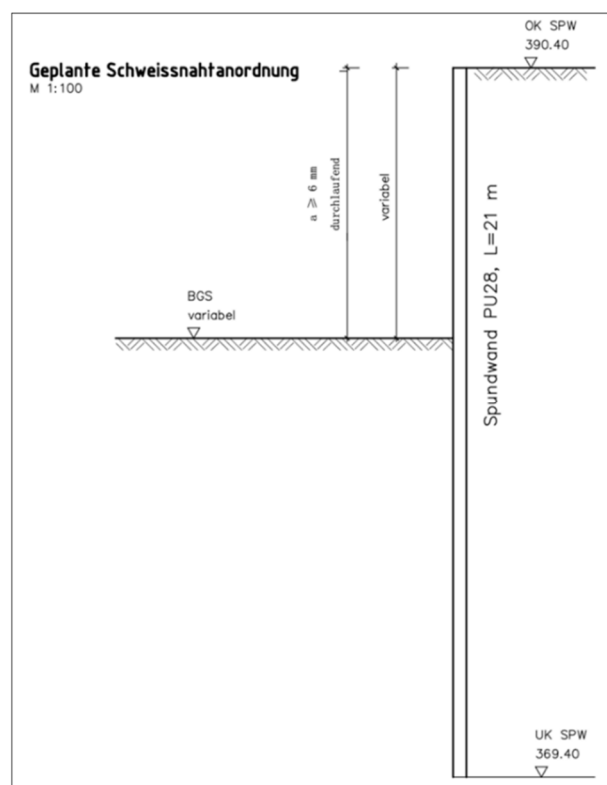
Coupe type d'une paroi avec la soudure
